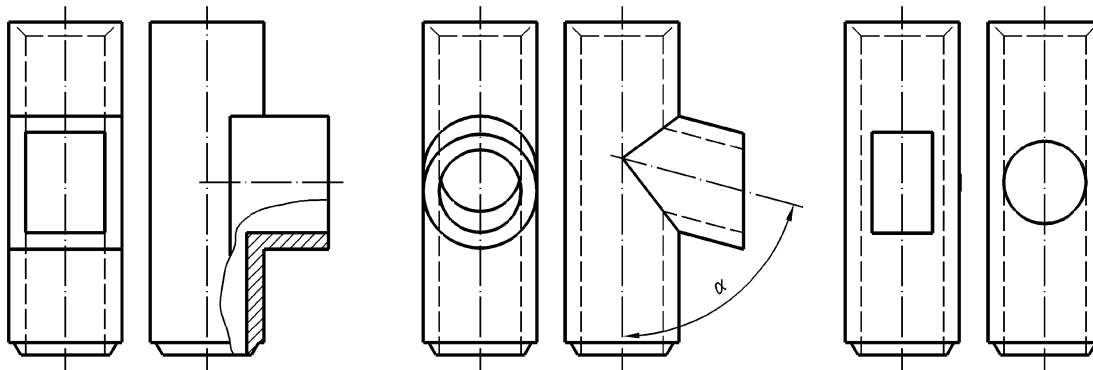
Beispiele für Inspektionsöffnungen und Anschlussformstücke
